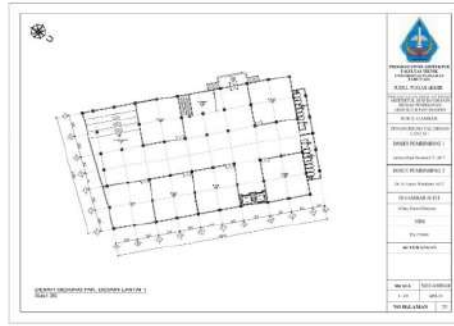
Denah Gedung Fak. Arsitektur Lantai 1
